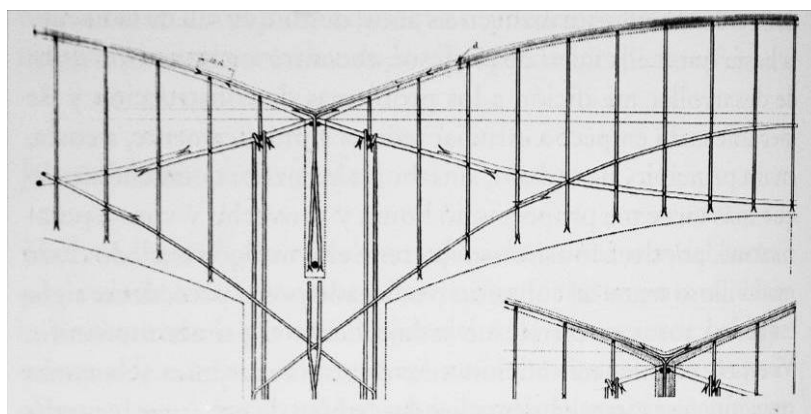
Sistema de placas bombeadas de hormigón armado patentado por J.M. de Zafra.
